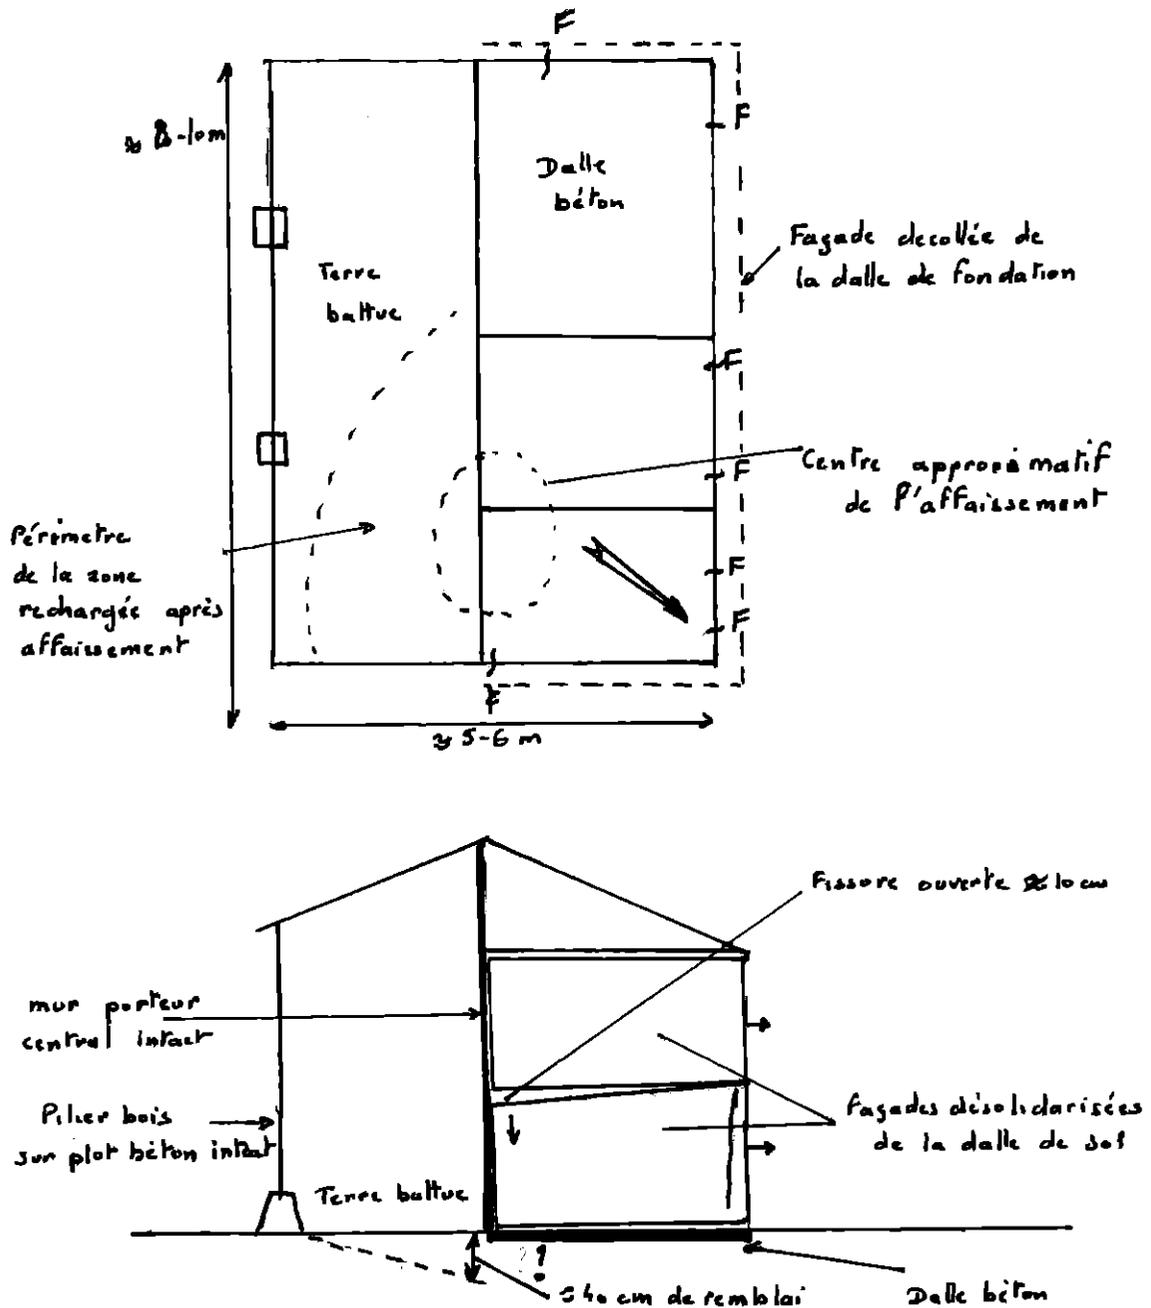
plan et coupe schématique du bâtiment (avec quelques unes des principales fissures) et de la zone d'affaissement, commune de Beuzeville (27).
